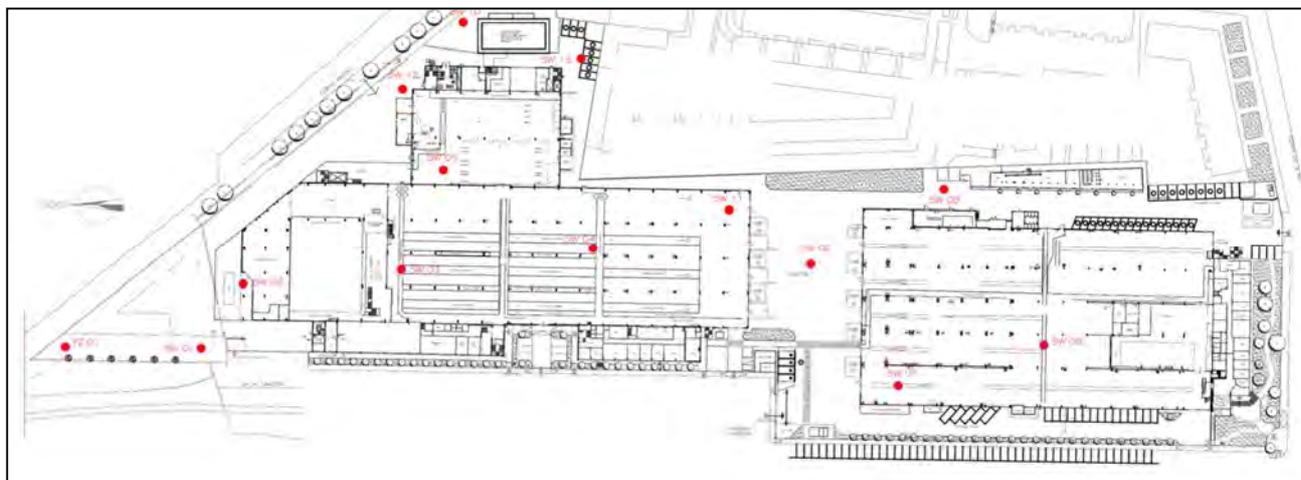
Planimetria impianto – Ubicazione sondaggi
